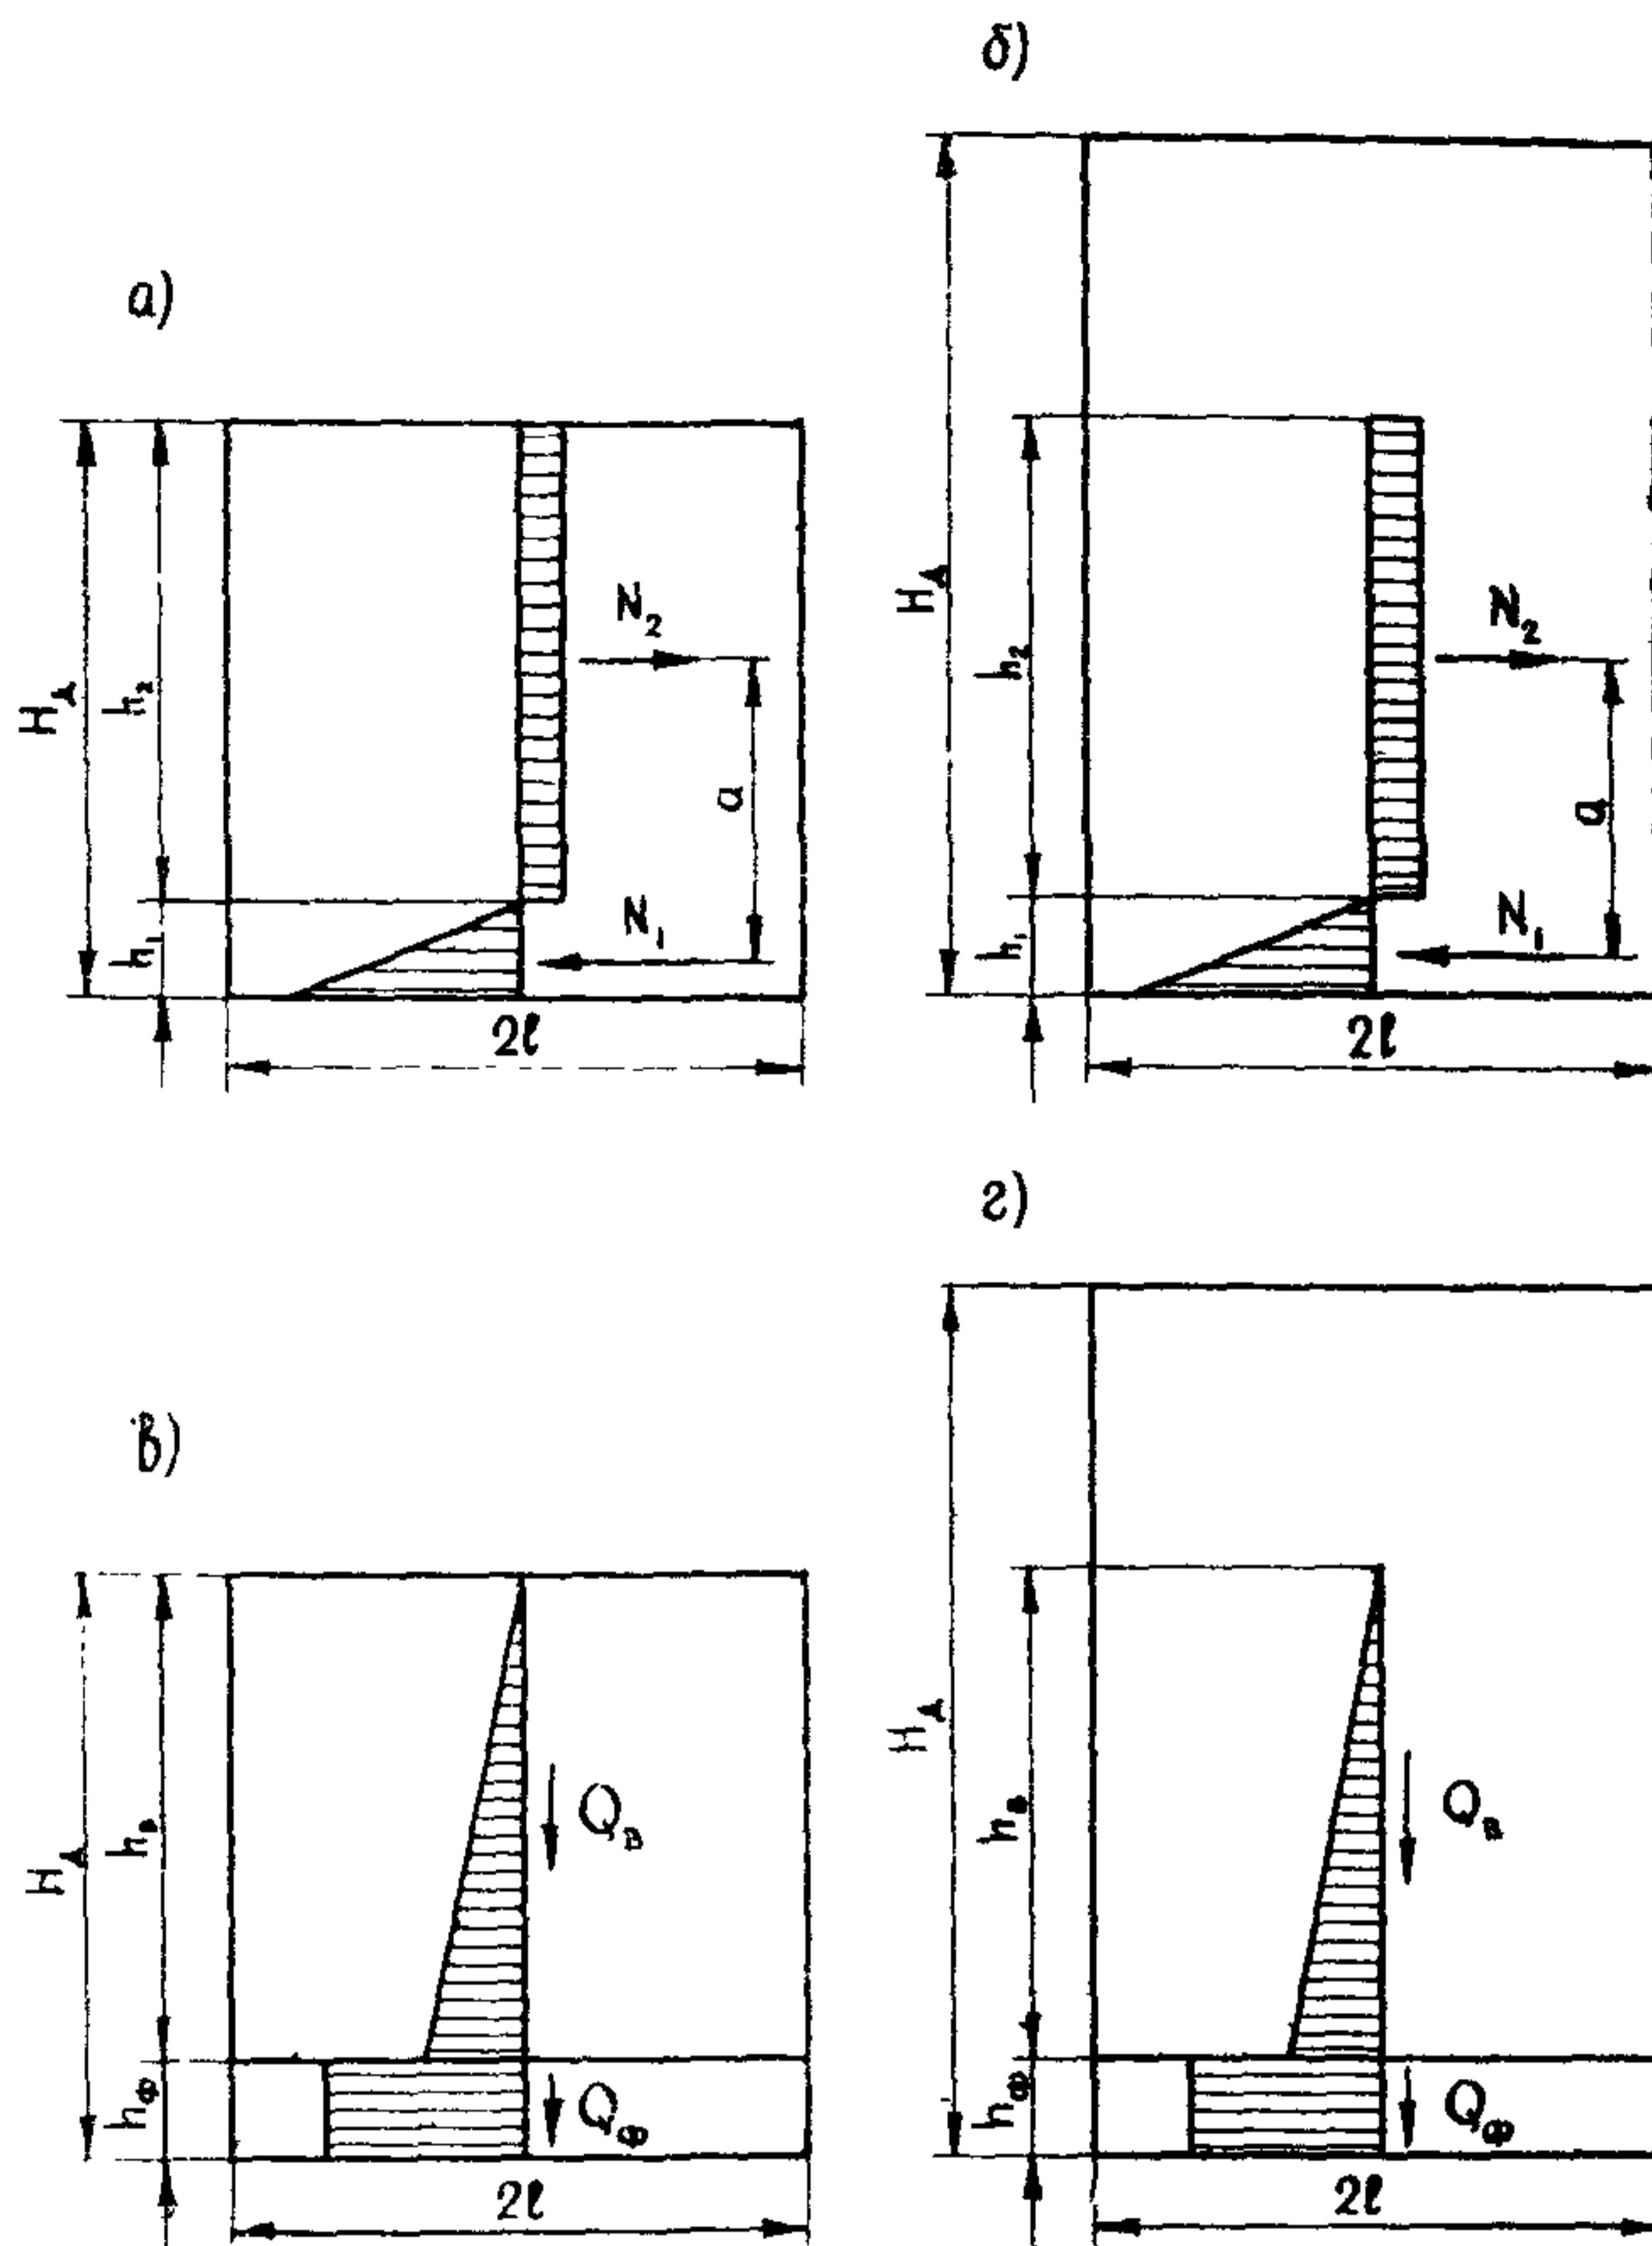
Схемы распределения продольных и поперечных усилий в сечениях здания (стены).
